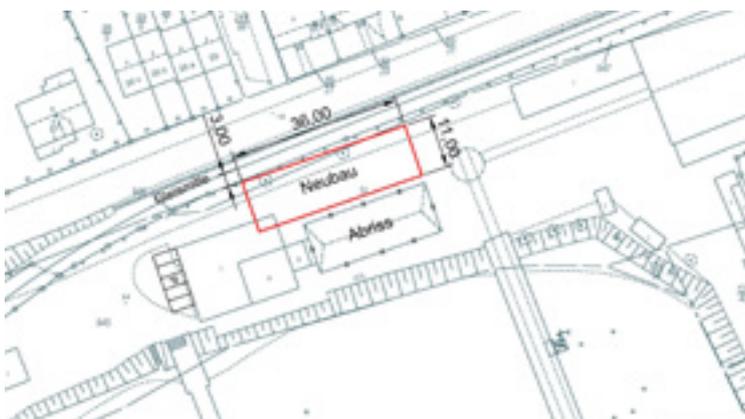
Lageplan mit Darstellung des Ersatzbaus für B3, Auszug aus Bauvorbescheid
